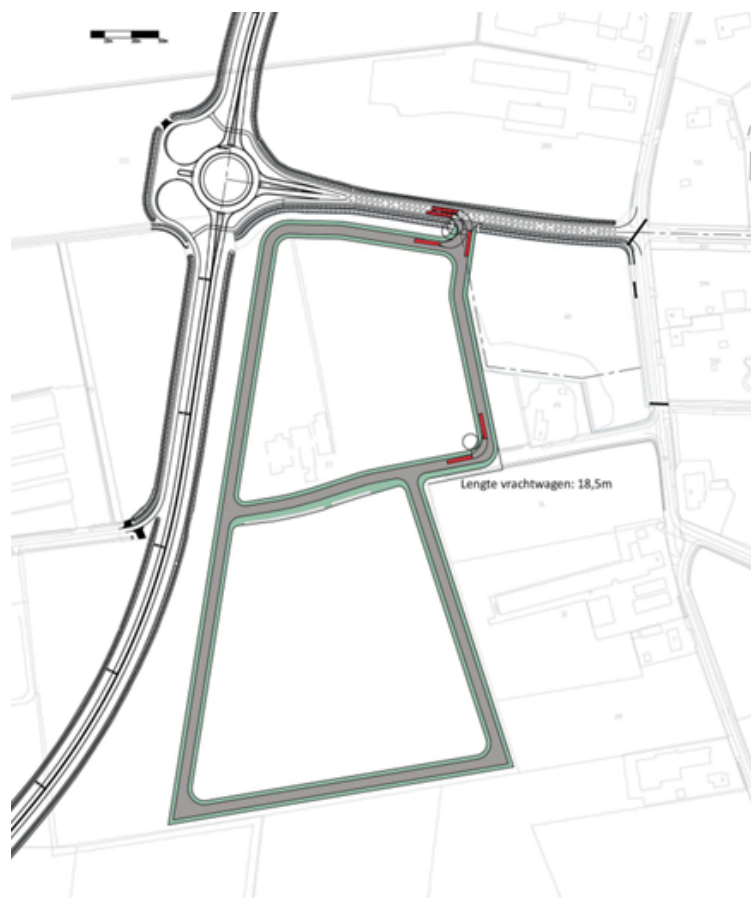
Huidige verkeersstructuur in omgeving plangebied
